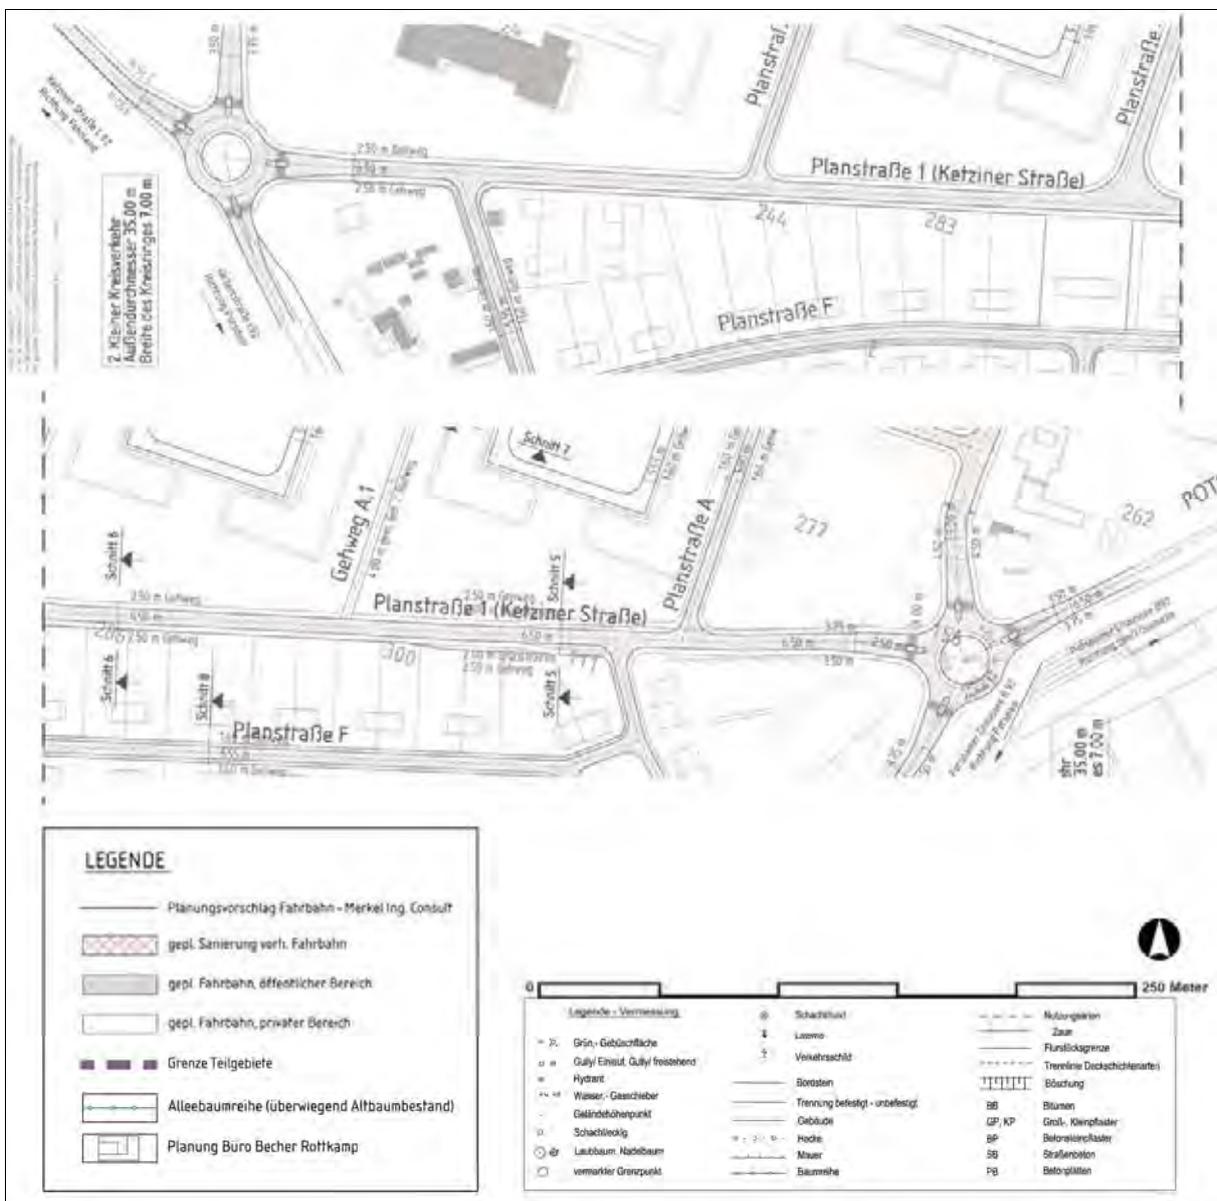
Erschließung, Planstraße 1/Ketziner Straße
